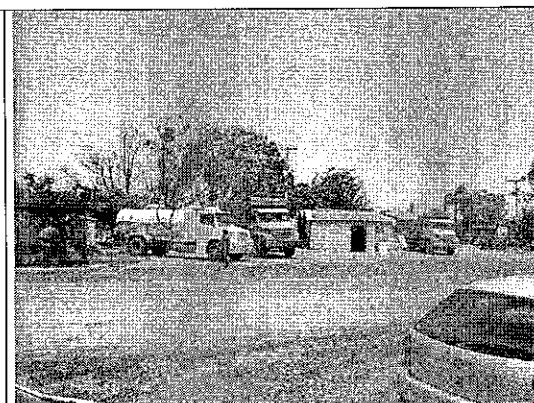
Local anexo à jazida. Dentro da área de domínio.
